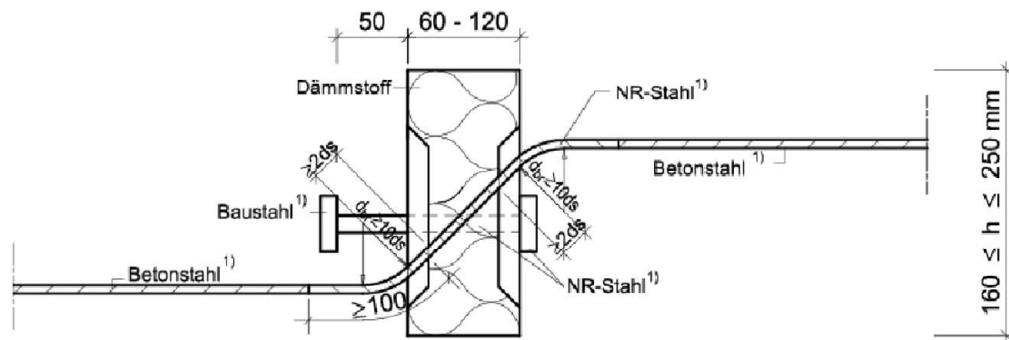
Schöck Isokorb® Typ Q-ID mit Stahldrucklager in eingebautem Zustand mit Vergussfuge
